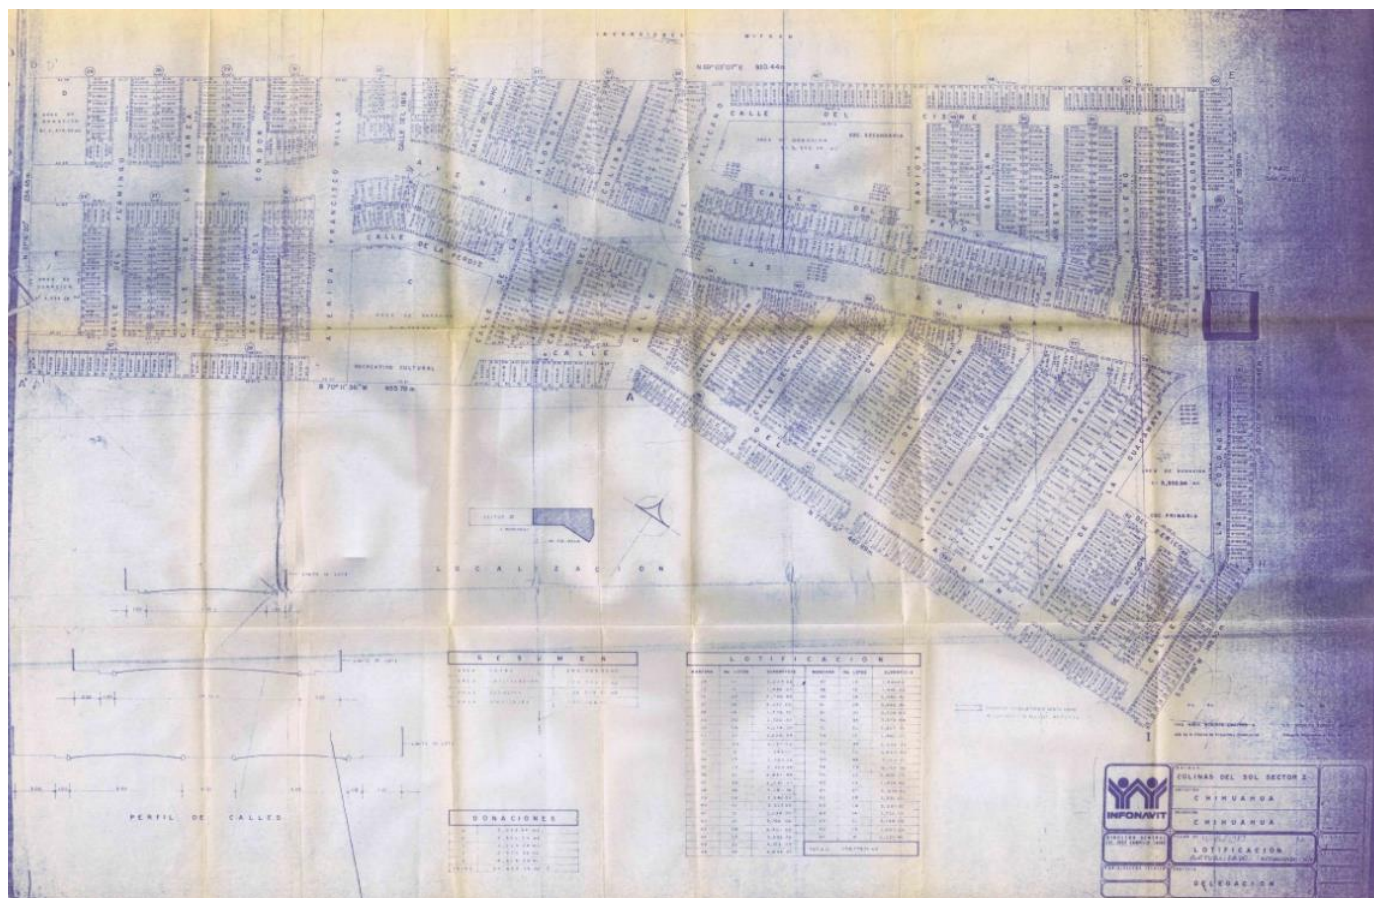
Copia del plano original del conjunto habitacional de INFONAVIT Colinas del Sol Sector I, 1989. Fuente: INONAVIT.
